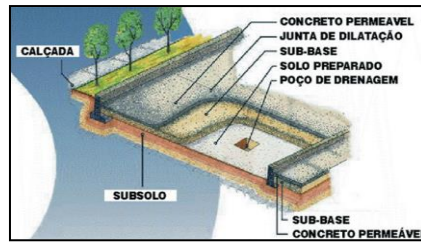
Exemplo no uso do concreto permeável na pavimentação. Fonte: Ibracon.
